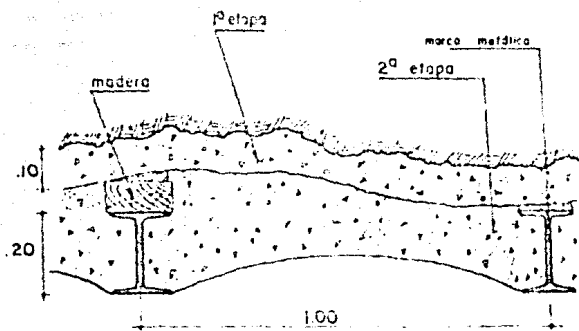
DETALLE DE COLOCACION DE CONCRETO LANZADO
